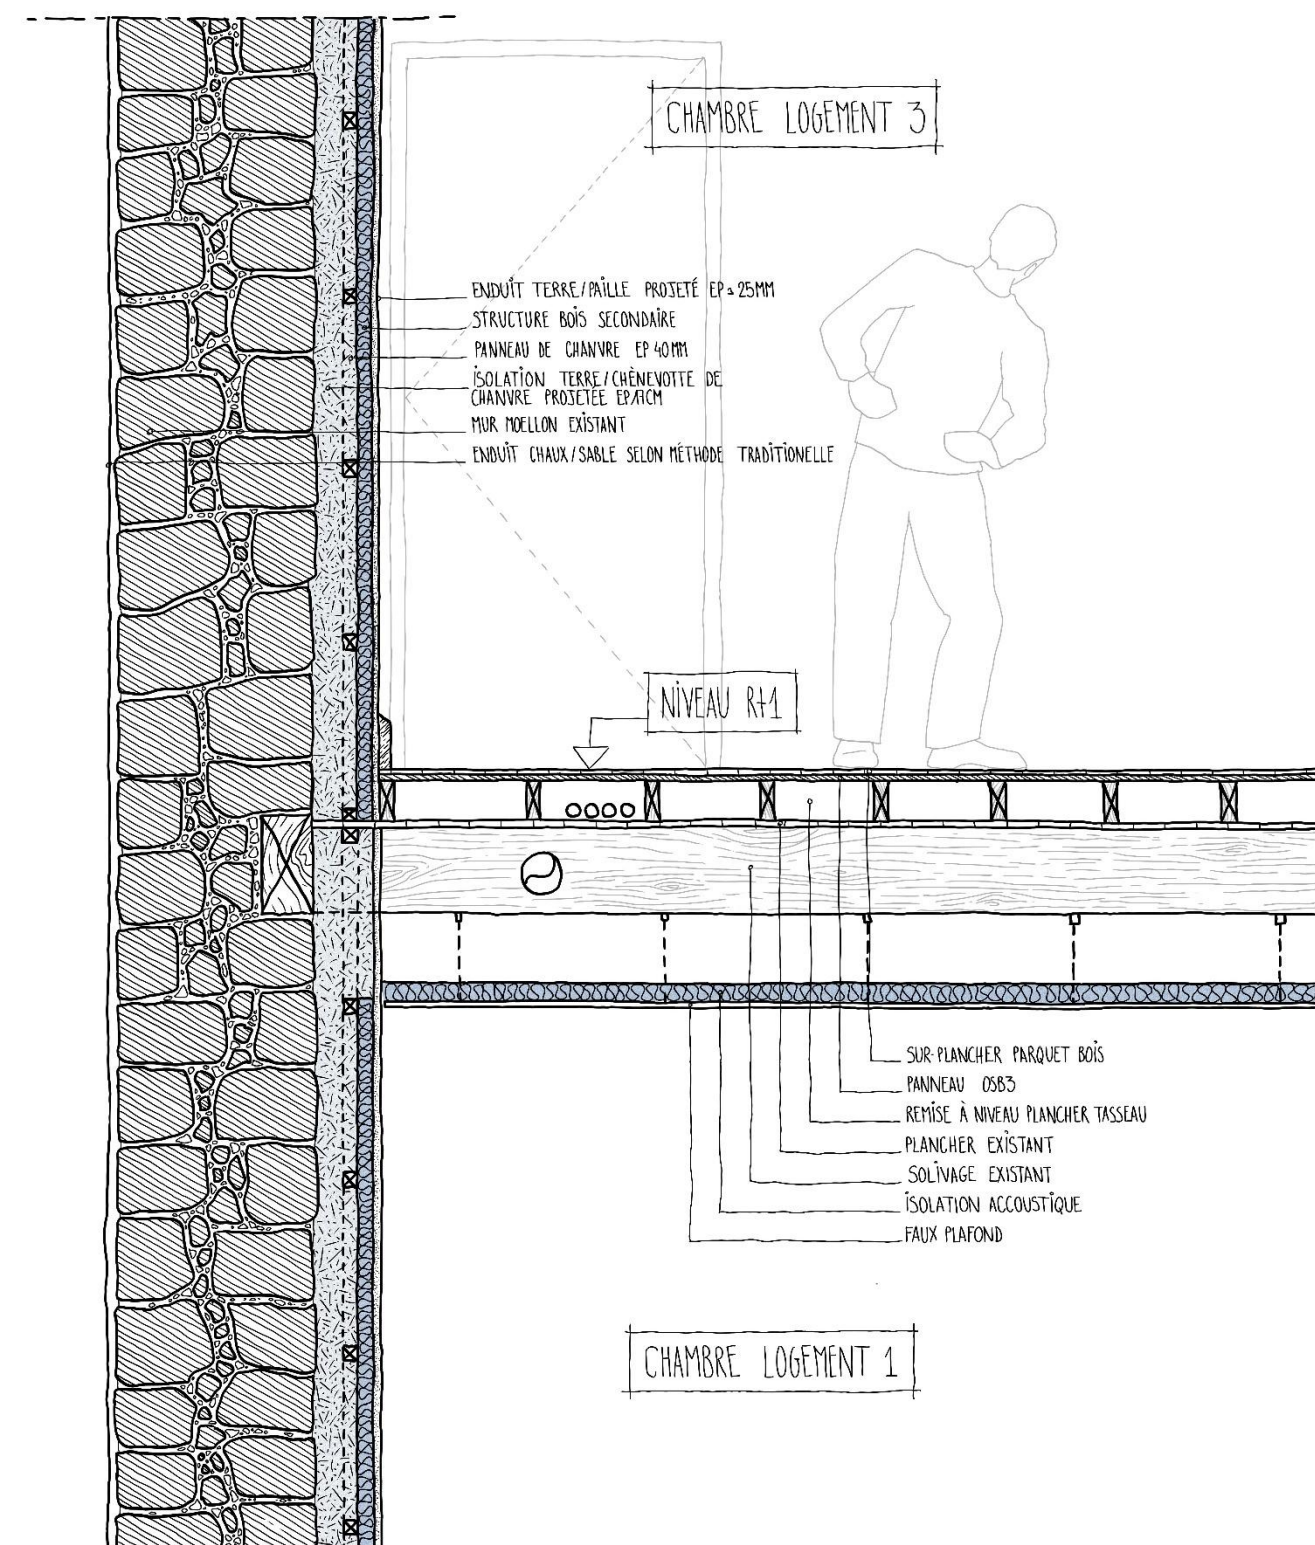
Croquis de la jonction de plancher intermédiaire (source Mayker Architectes)
